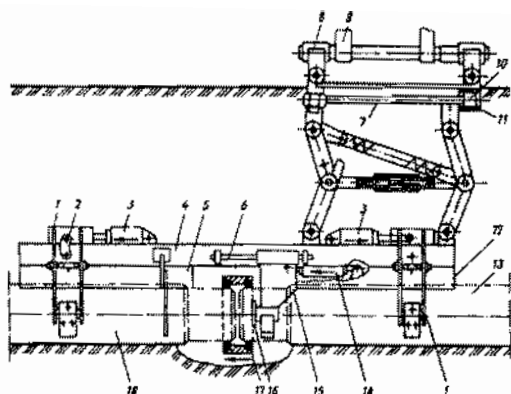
Устройство для монтажа асбестоцементных труб: 1 - челюстные захваты трубы; 2 - кривошип; 3 - силовой цилиндр; 4 - рама; 5, 12 - центрирующие швеллеры; 6 - направляющие; 7 - горизонтальный стержень; 8 - кронштейны; 9 - стрела крана; 10 - ролик; 11 - роликовая дорожка; 13 - труба; 14 - торцевой управляемый силовой цилиндр; 15 - торцевой захват; 16 - толкающие винты; 17 - муфта; 18 - трубопровод
